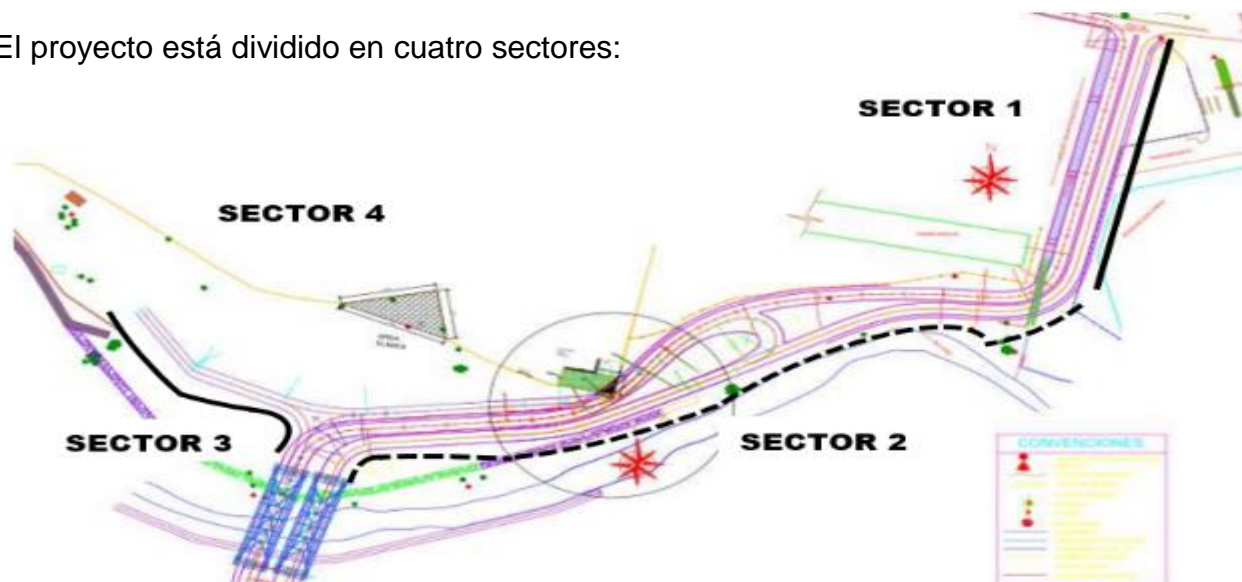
Plano general del proyecto. Fuente: CPL 2017
